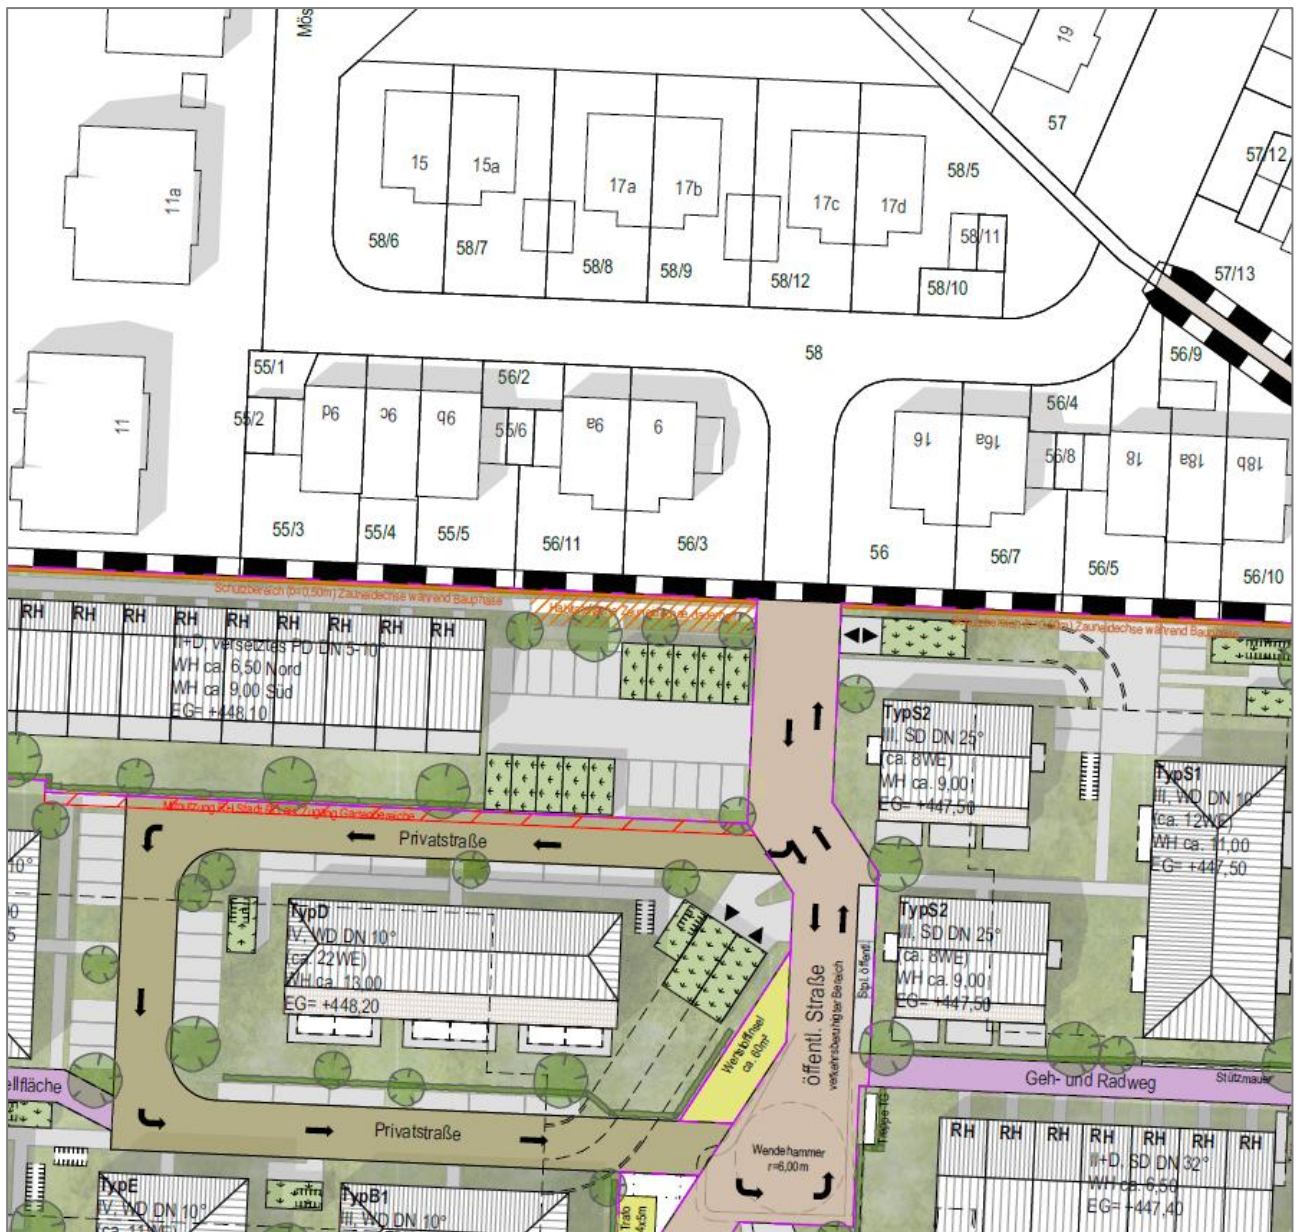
Anschluss Verdichtung B-Plan Möslstraße an den Bestand, Plangrundlage: Planungsgruppe Strasser
